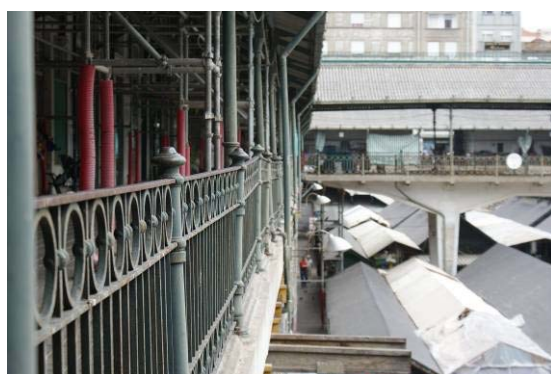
Deformação estrutural da galeria interior na zona sul do Mercado.
